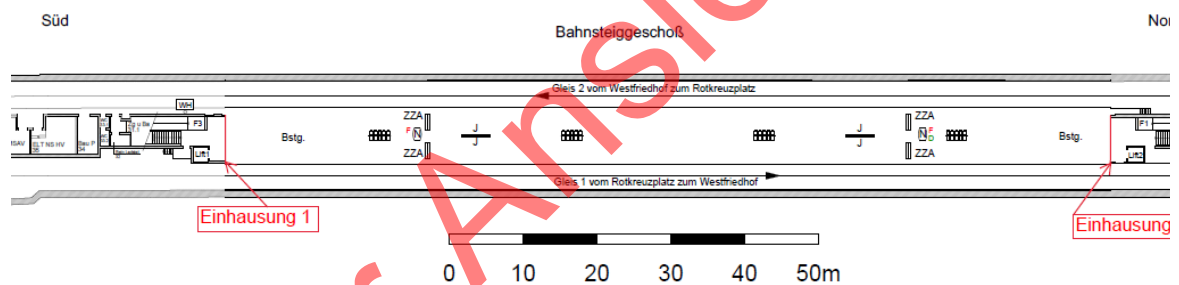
Grundriss Bahnsteiggeschoss, Einhausungen
